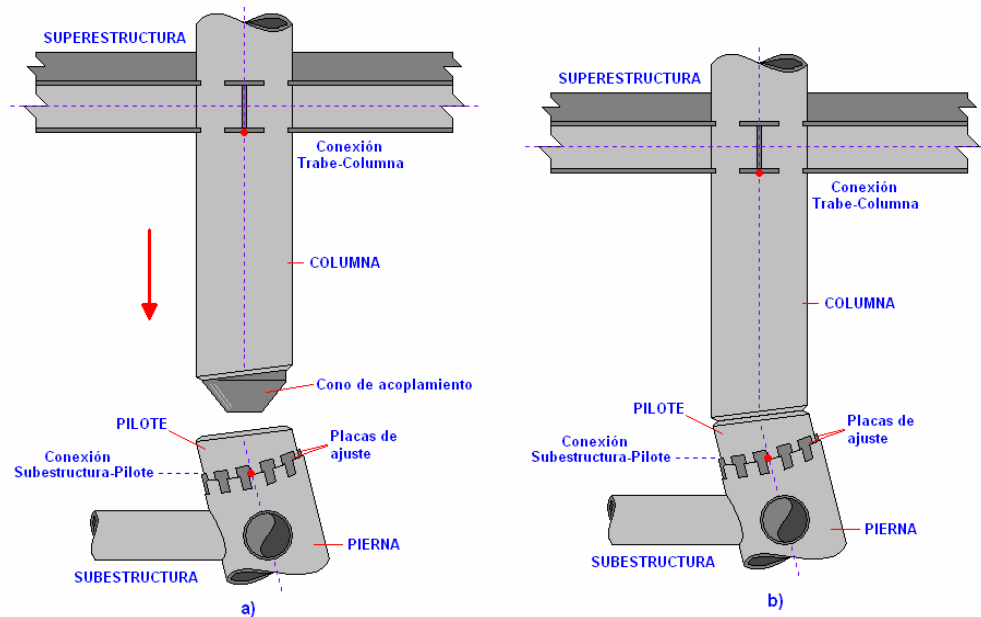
Acoplamiento de las piernas de la superestructura con los pilotes.
